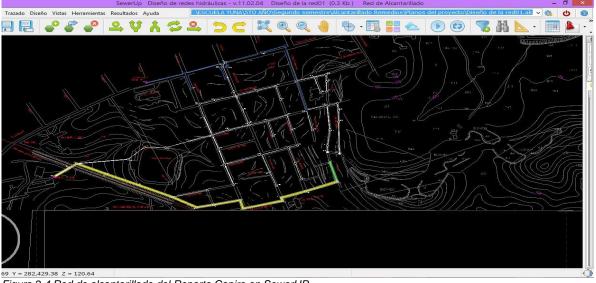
Red de alcantarillado del Reparto Capiro en SewerUP.
